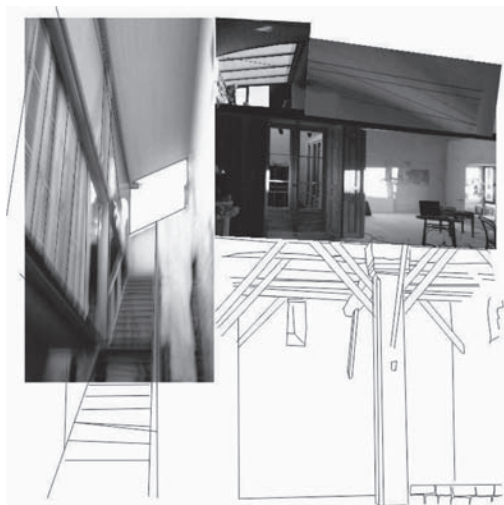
Montaje sobre la sección transversal. (Autor: M. Macho).
